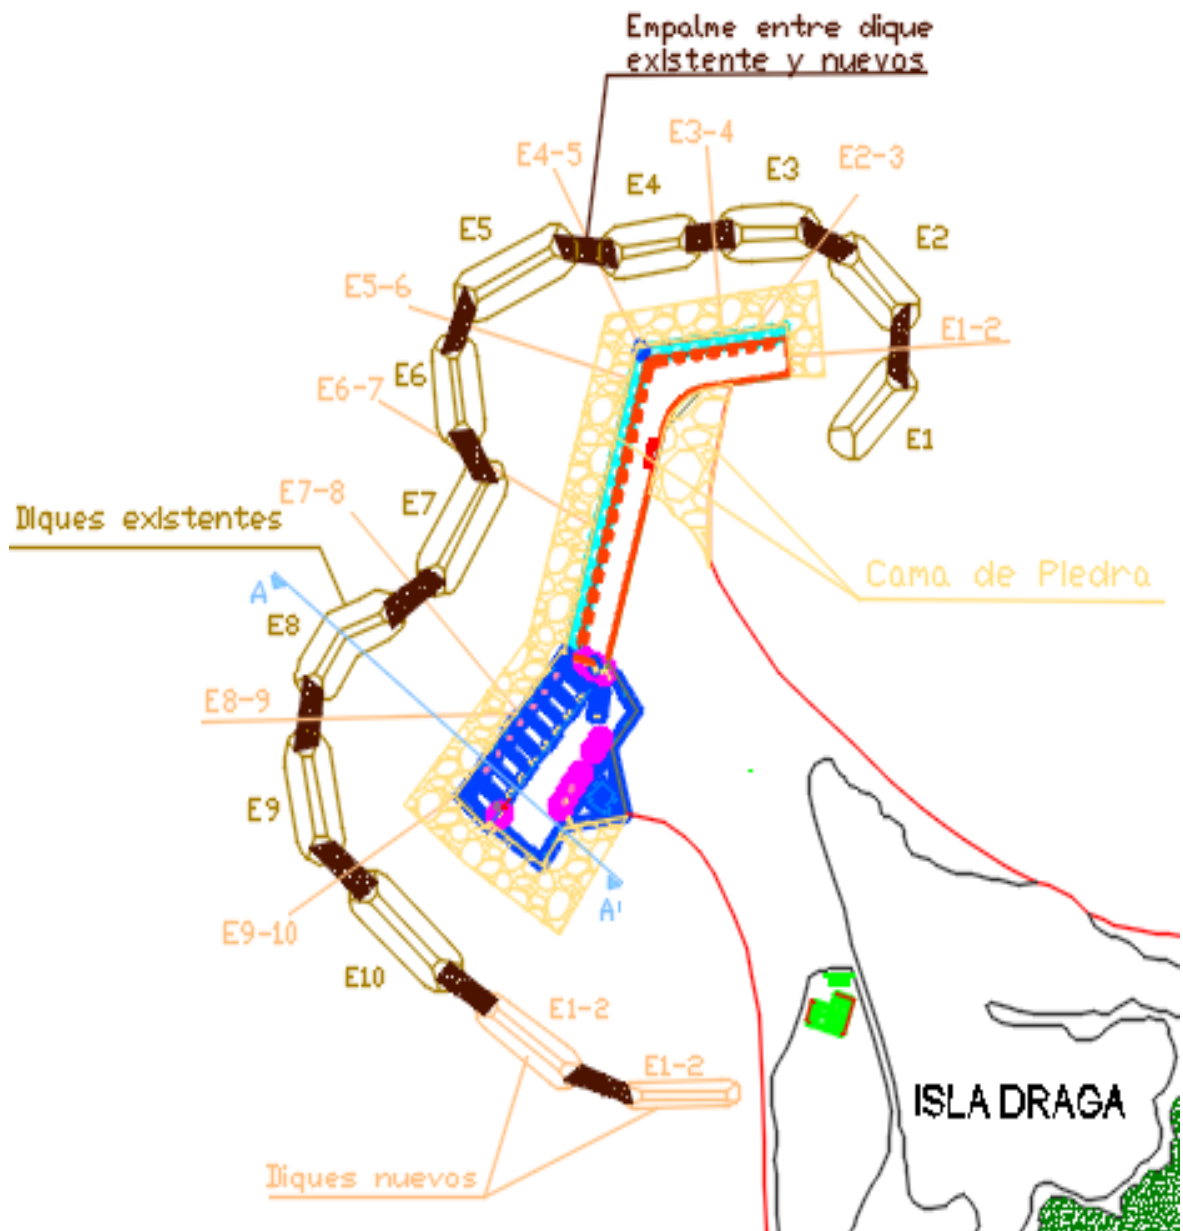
Esquema, vista en planta de propuesta de estabilización de la base del Fuerte- Batería San José. Berrocal, A. (2016) [Ilustración]. Recuperado de “*Planos Fuerte Batería de San José, Herrera A, (2012)*”.
